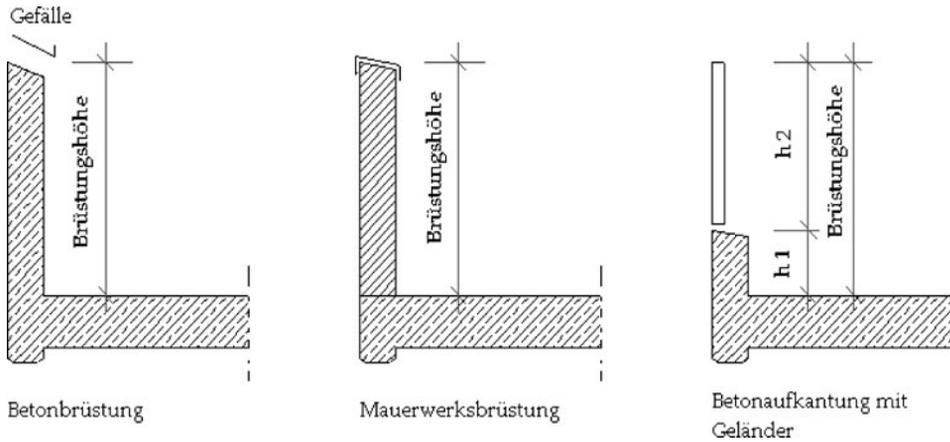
Geschlossene Brüstungen, mit Gefälle zur Fußbodenentwässerung (Notüberläufe erforderlich!) Brüstungshöhen:
